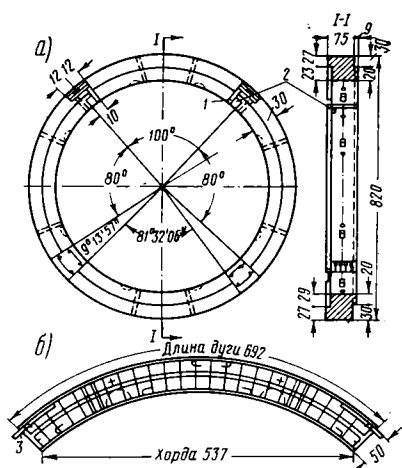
Сборная обделка из железобетонных блоков со стыками с петлевой арматурой:
